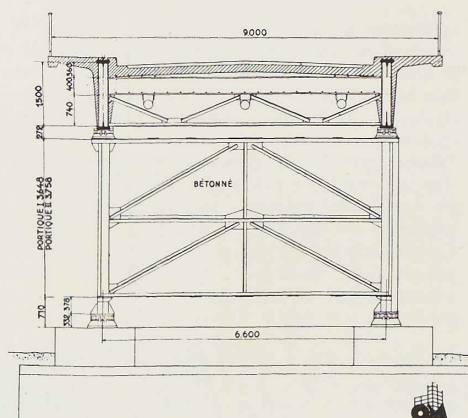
Coupe transversale au droit d'un portique du pont de Gisikon.
